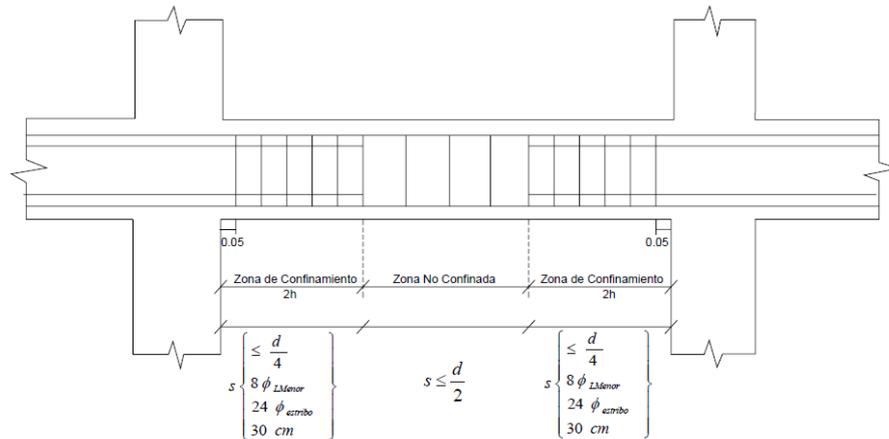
PREDIMENSIONAMIENTO DE VIGAS
